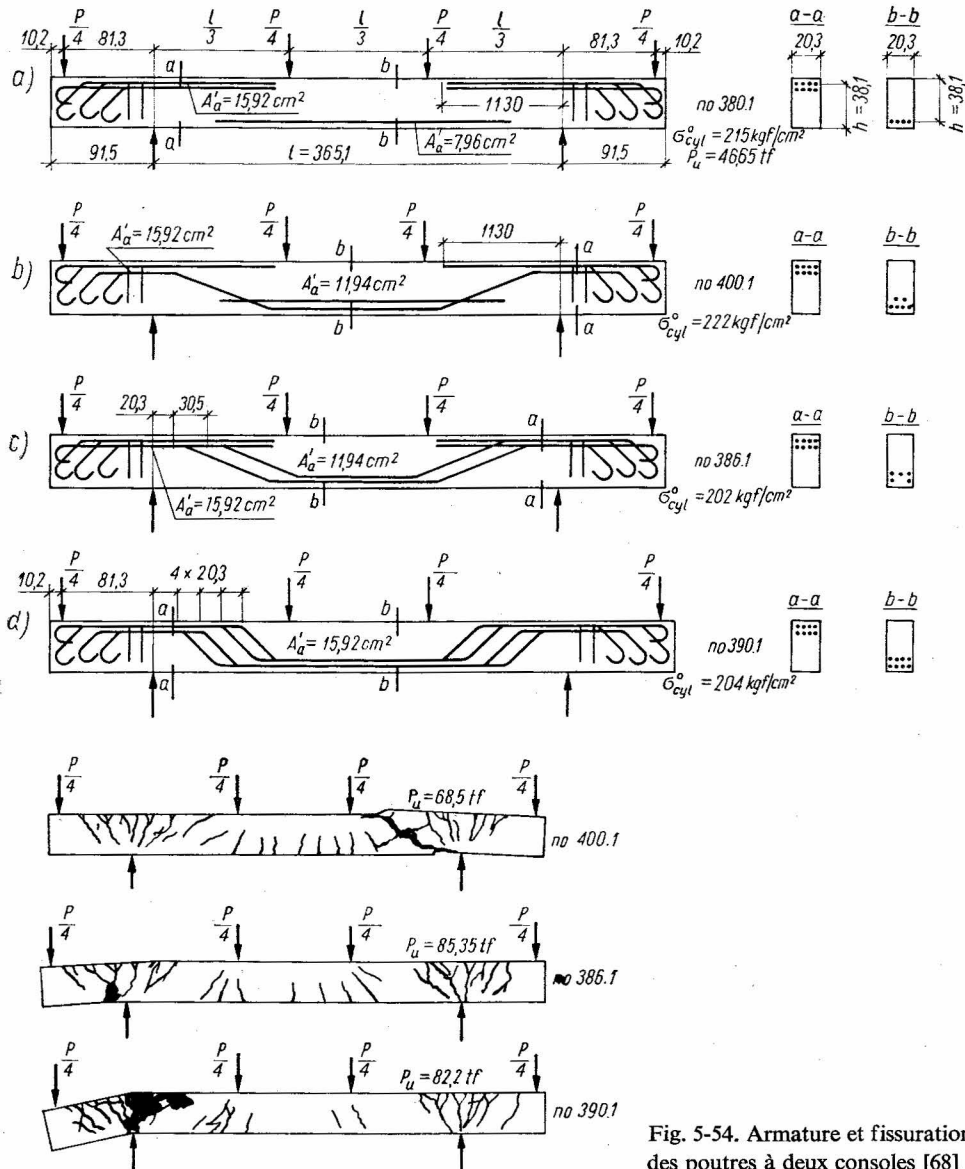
Armature et fissuration des poutres à deux consoles [68]
